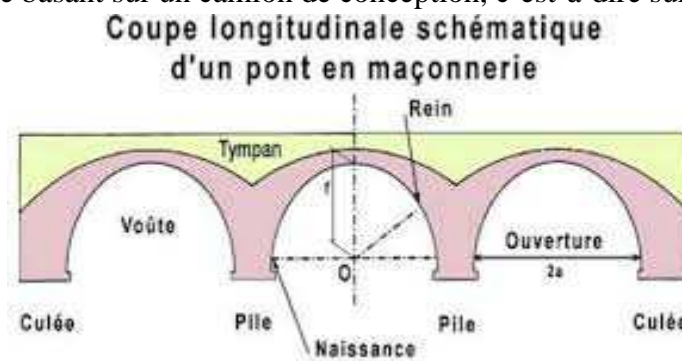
coupe longitudinale d'un pont en maçonnerie [2].
